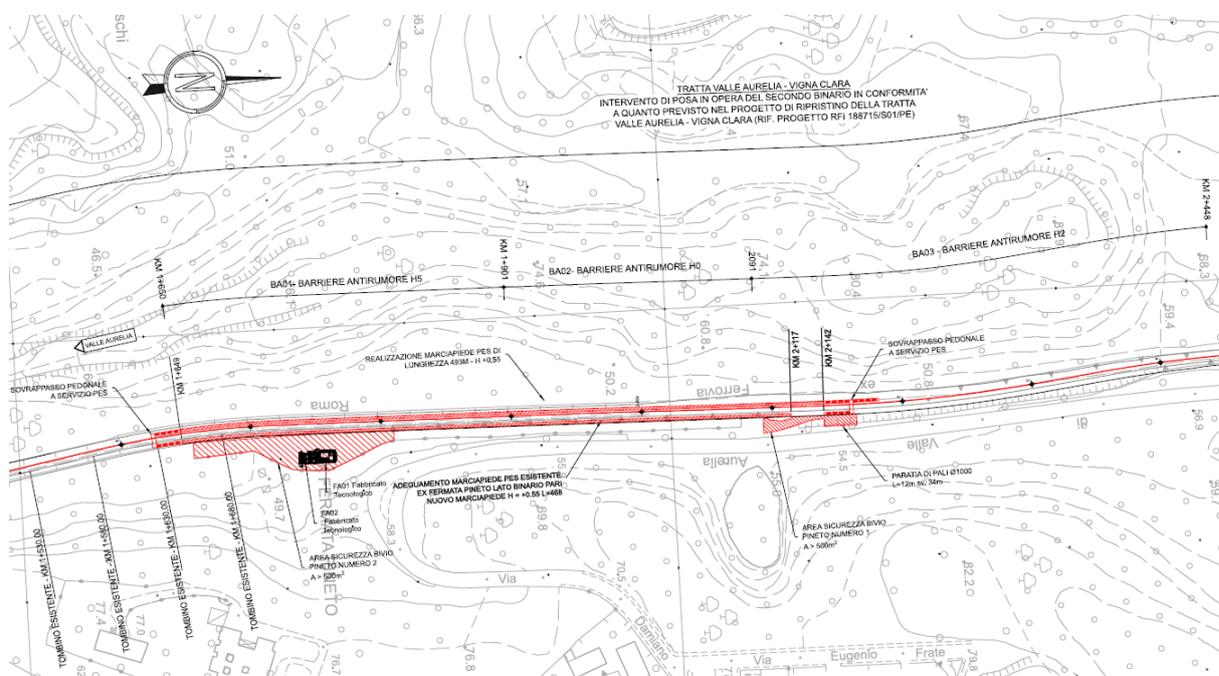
Intervento in progetto: stralcio planimetrico zona Bivio Pineto.
